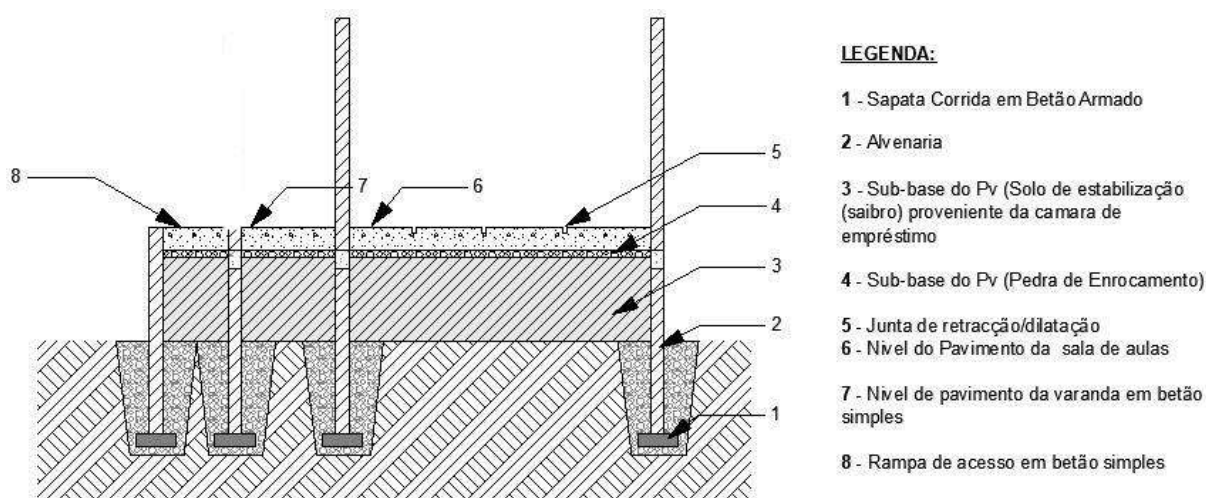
Secção transversal do pavimento executado nas salas de aulas das escolas em referência. (Fonte: Autor)
